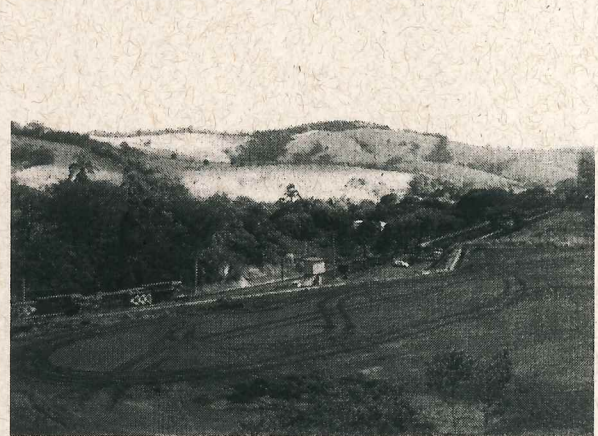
ADA em primeiro plano e antigo bairro plataforma ao fundo.
